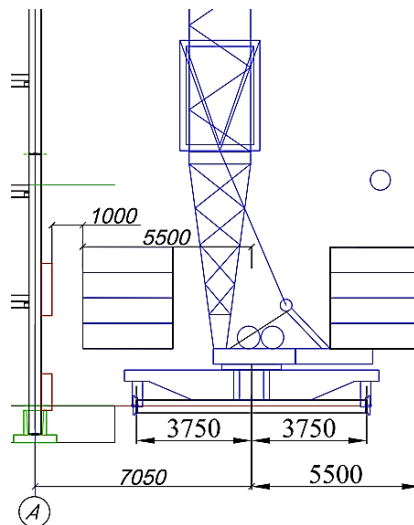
Схема прив'язки крану КБ-503А до будівлі.
